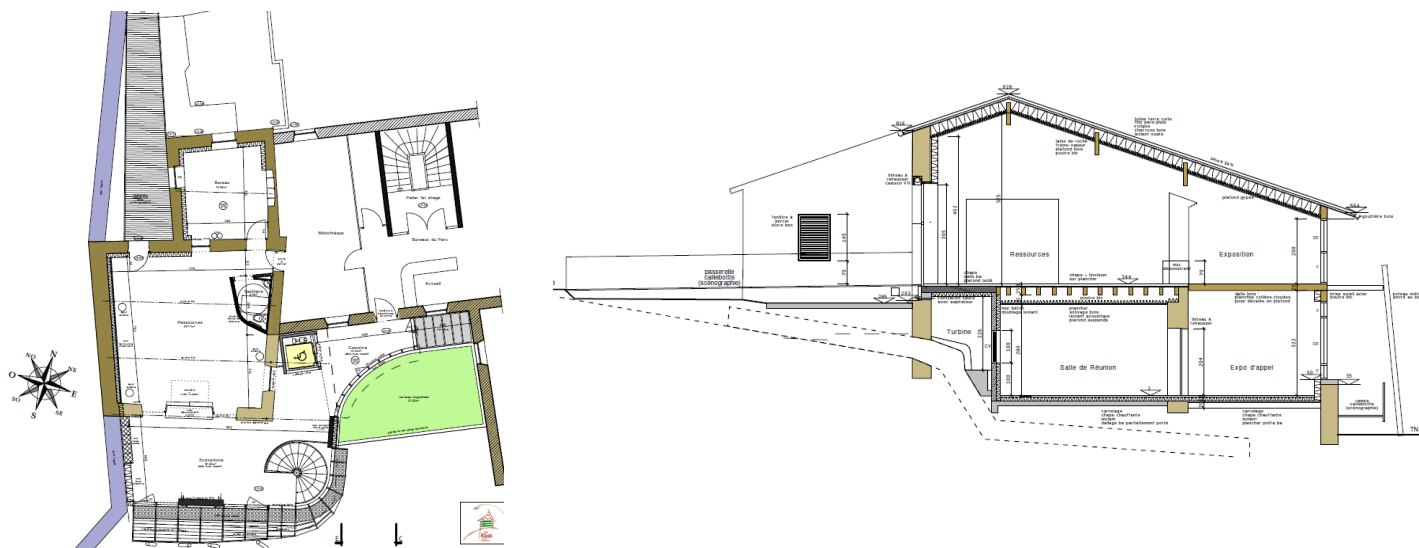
Plan de l'étage et coupe Nord-Sud : dénivelé d'un étage entre le parvis au Sud et le jardin au Nord
